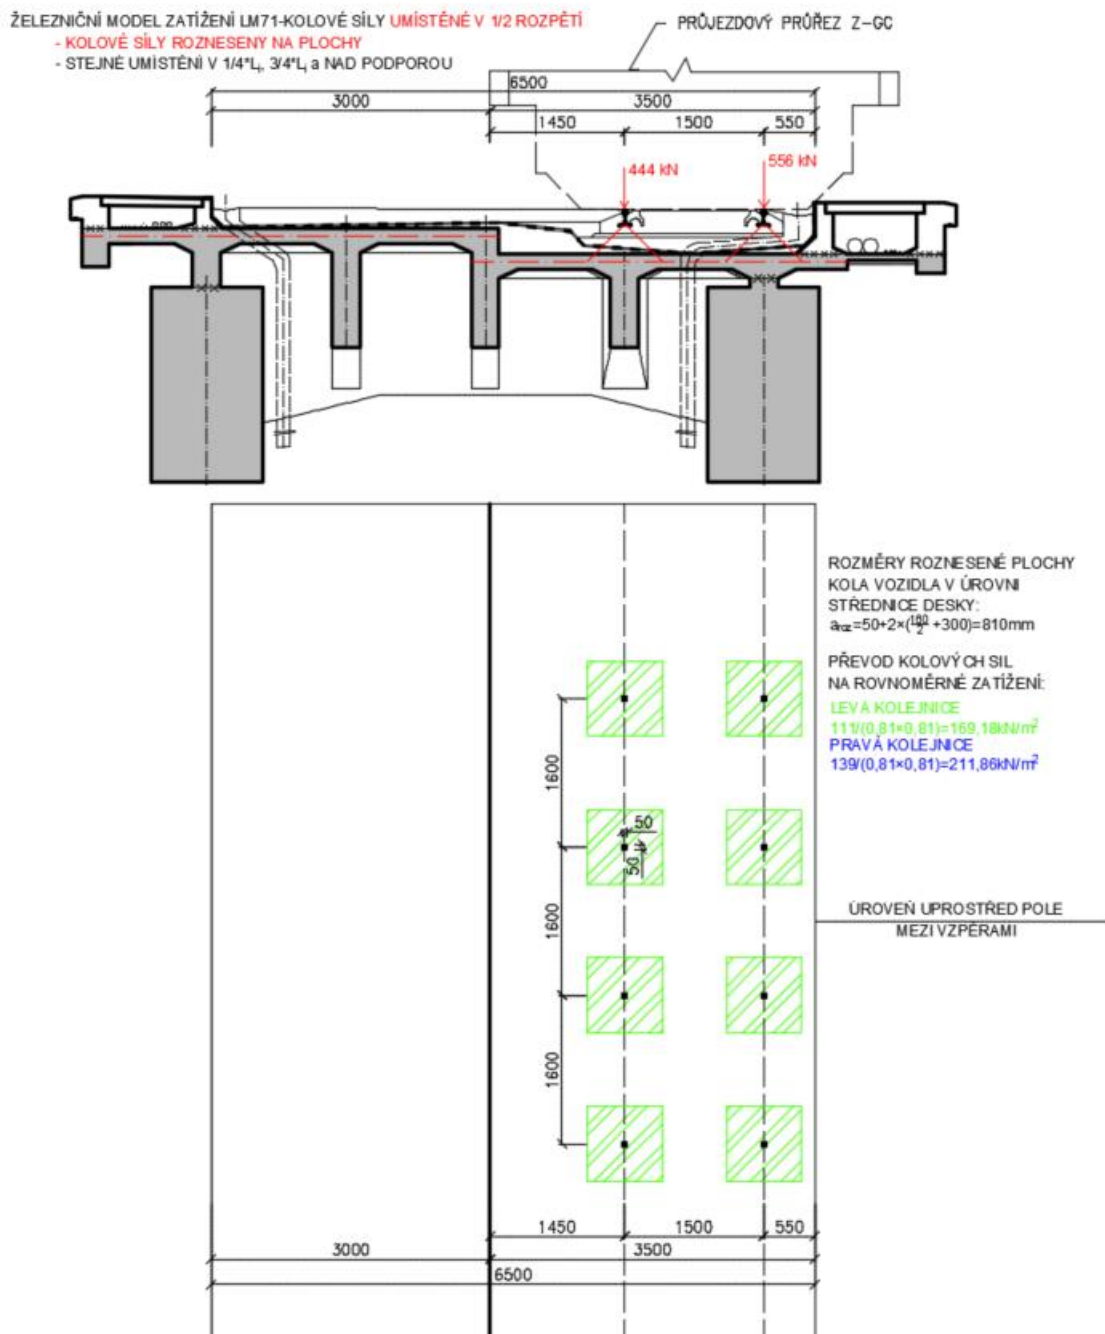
Schéma umístění kolových sil modelu LM71– varianta 2
